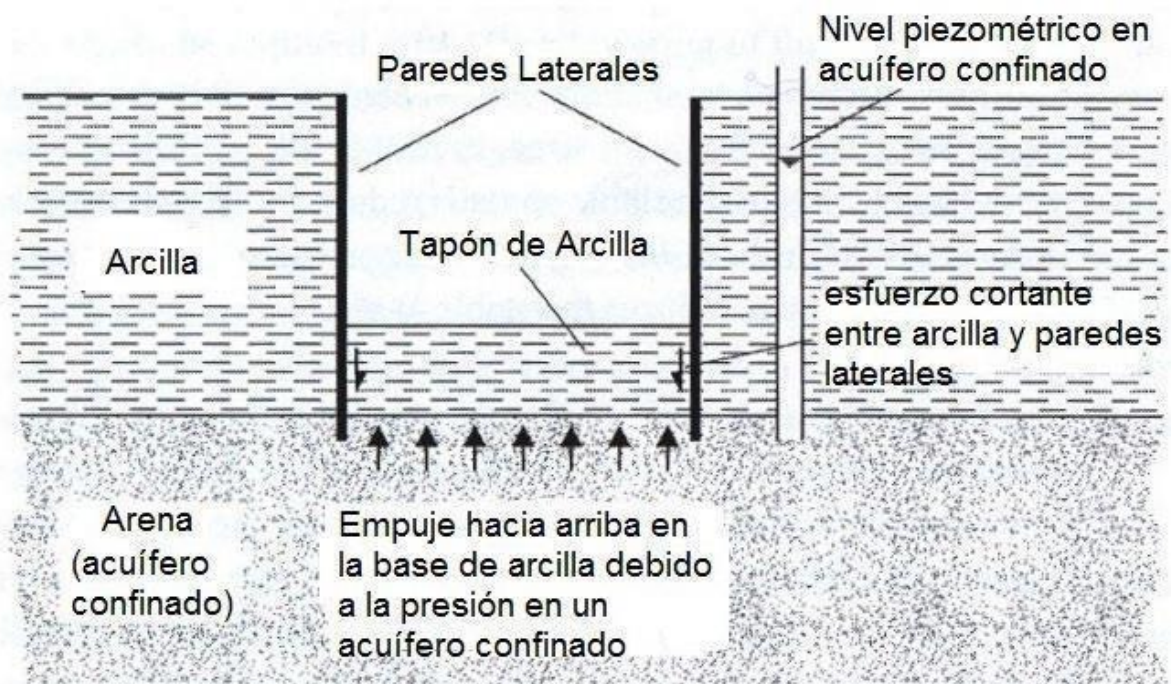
Levantamiento del fondo debido a la excavación en un suelo de baja permeabilidad sobre un acuífero confinado, en recinto delimitado por diafragma.
